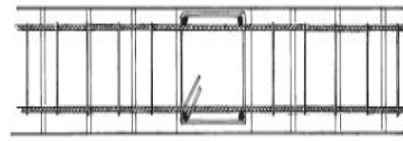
Unión viga columna – detalle en planta (Blondet, 2005).
